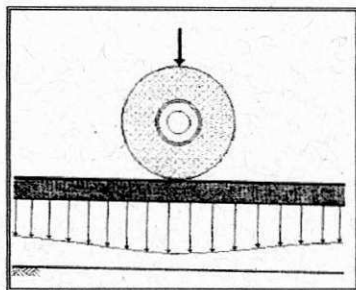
Distribuição do carregamento em uma placa do pavimento rígido
